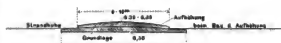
Senkstück mit Aufhöhung in Packwerk.
